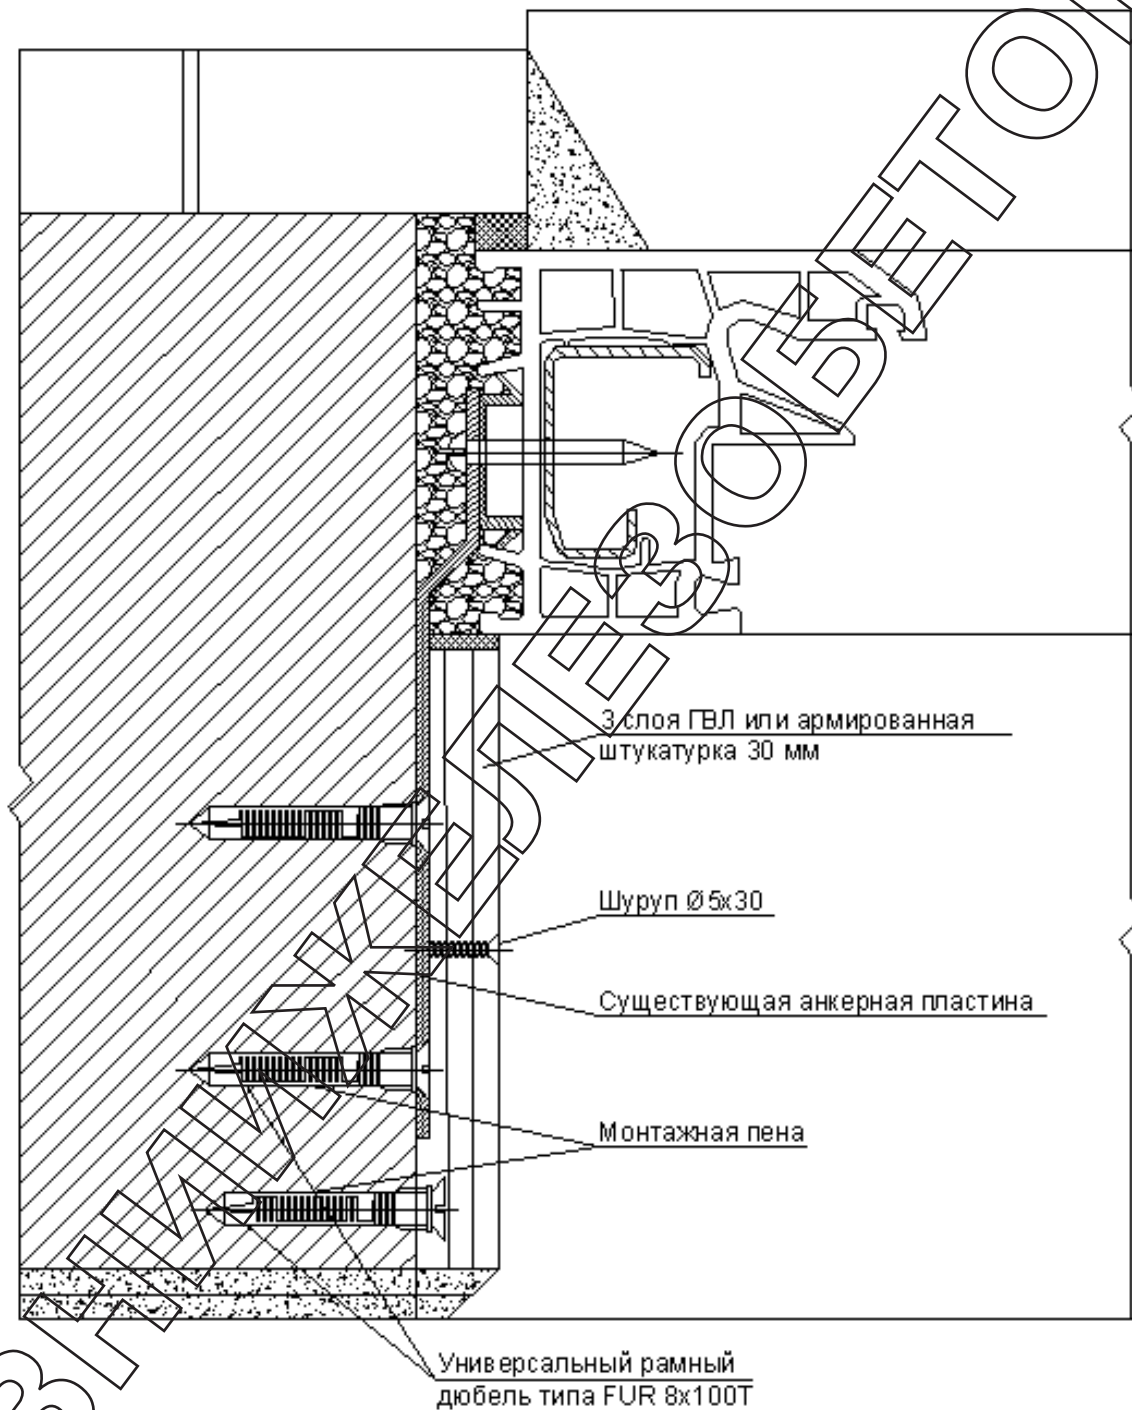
Вариант крепления оконных блоков к полистиролбетонным стенам.
